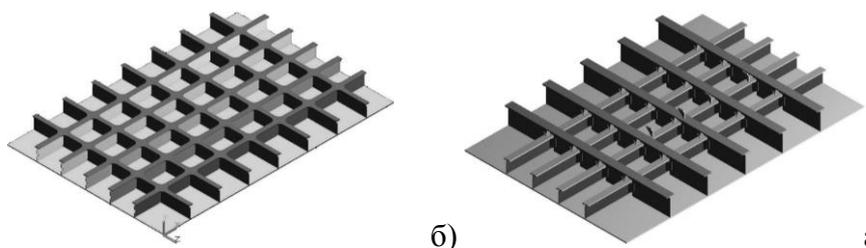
Конструкции перекрытия ледового пояса морской ледостойкой стационарной платформы: а) традиционная; б) оптимизированная
